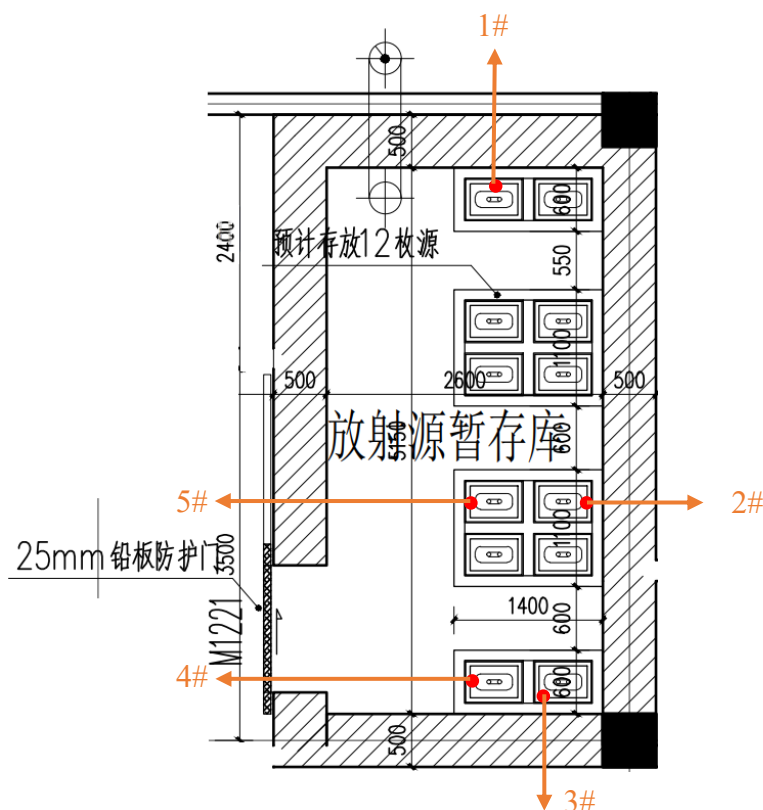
放射源暂存库平面布局及预测点位示意图（单位：mm）
